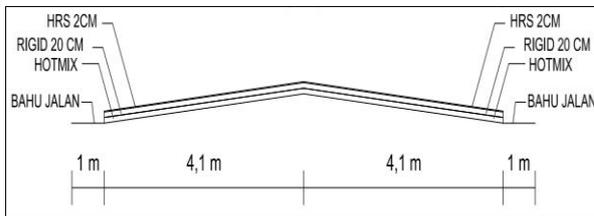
Geometrik Melintang Jalan Kom. Yos. Sudarso Sebelum Peningkatan Struktur Badan Jalan
